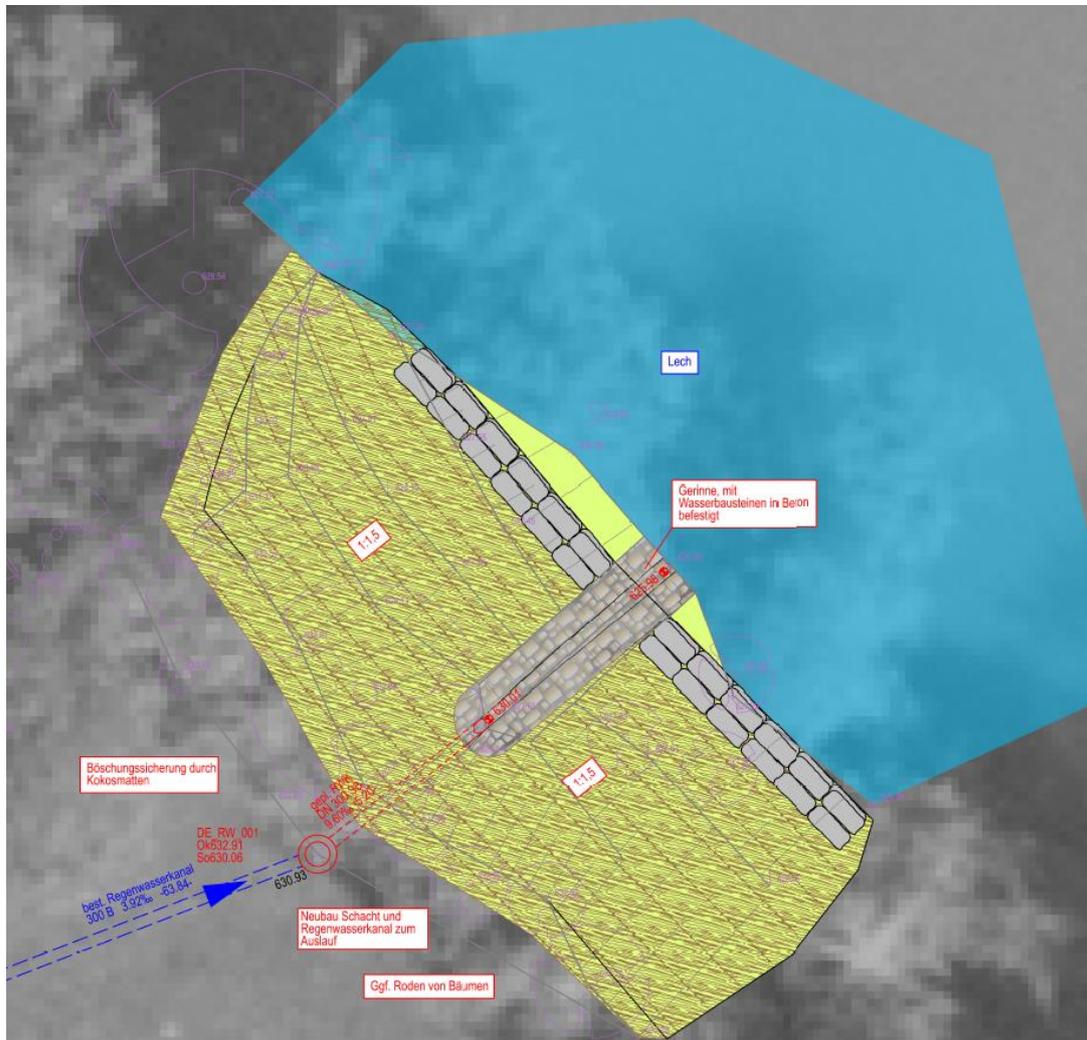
Ausschnitt aus Lageplan 118127-03-HW
